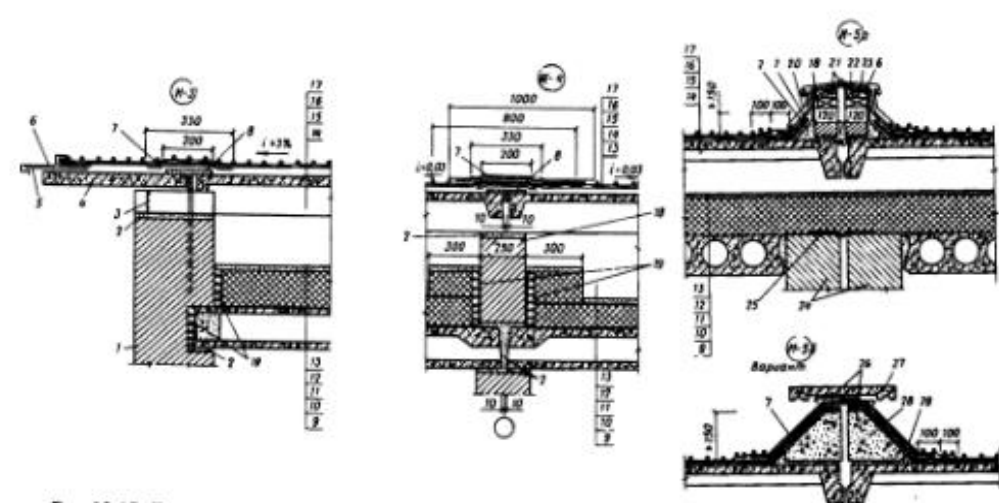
Узлы сопряжений конструкций безрулонной крыши с теплым чердаком (тип Г): 1 – фризловая панель; 2 – гернит; 3 – герметизирующая мастика; 4 – бетонный парапет; 5 – утеплитель; 6 – трехслойная кровельная панель; 7 – цементно-песчаный раствор; 8 – двухслойная кровельная панель; 9 – П-образный бетонный нащельник; 10 – лотковая трехслойная панель; 11 – лотковая двухслойная панель
